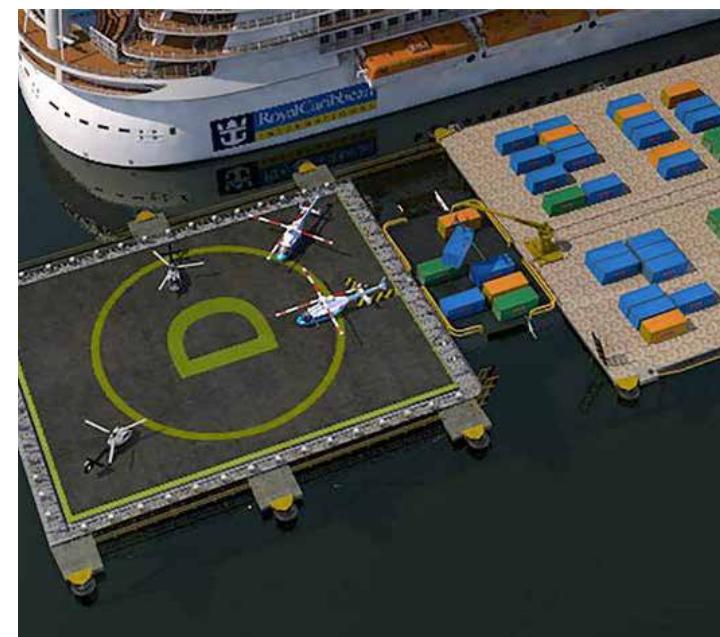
Perspectiva em 3D da caixa de colisão onde será estabelecido o heliponto, o local para atracação das embarcações de apoio, e área de apoio e suporte operacional.
